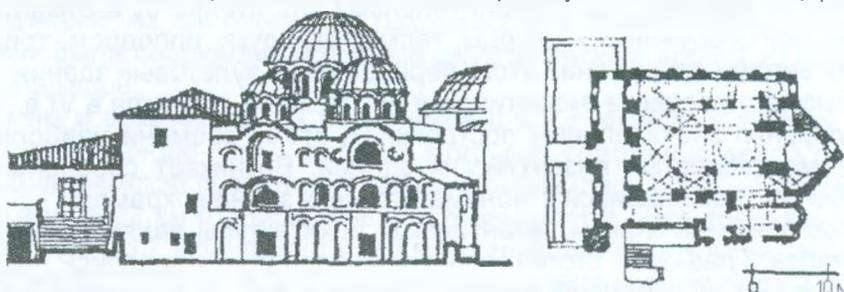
Мечеть Фетие - Джамии в Константинополе. Фасад, план
